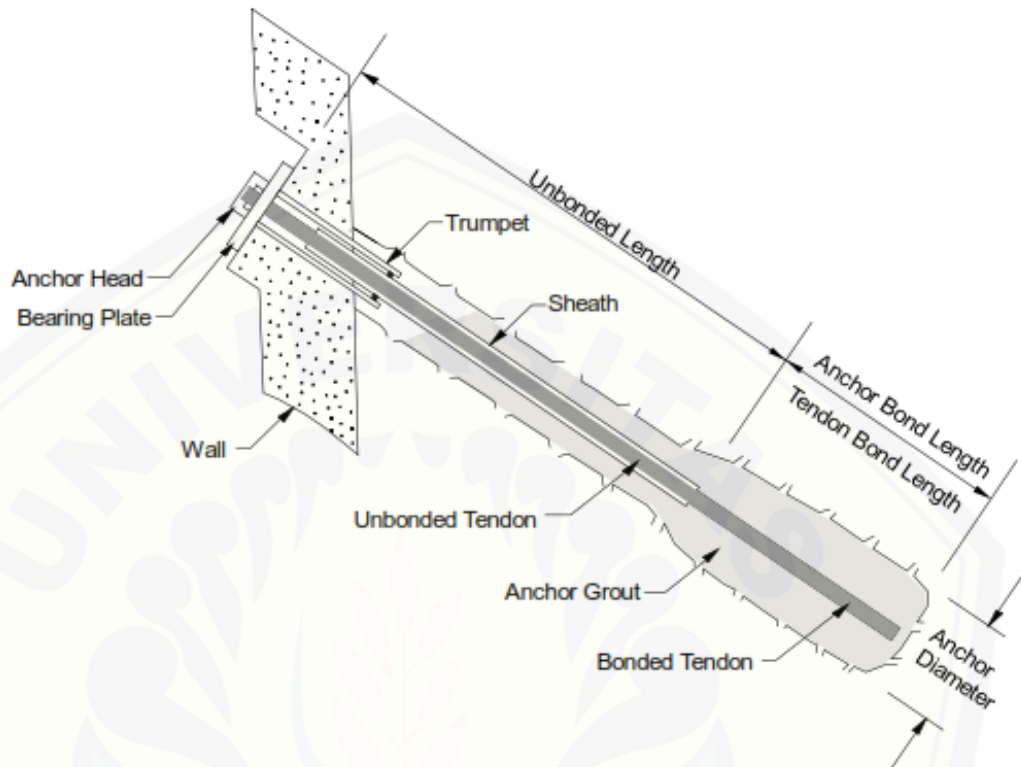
Secant Pile Dengan Ground Anchor Dan Tulangan
